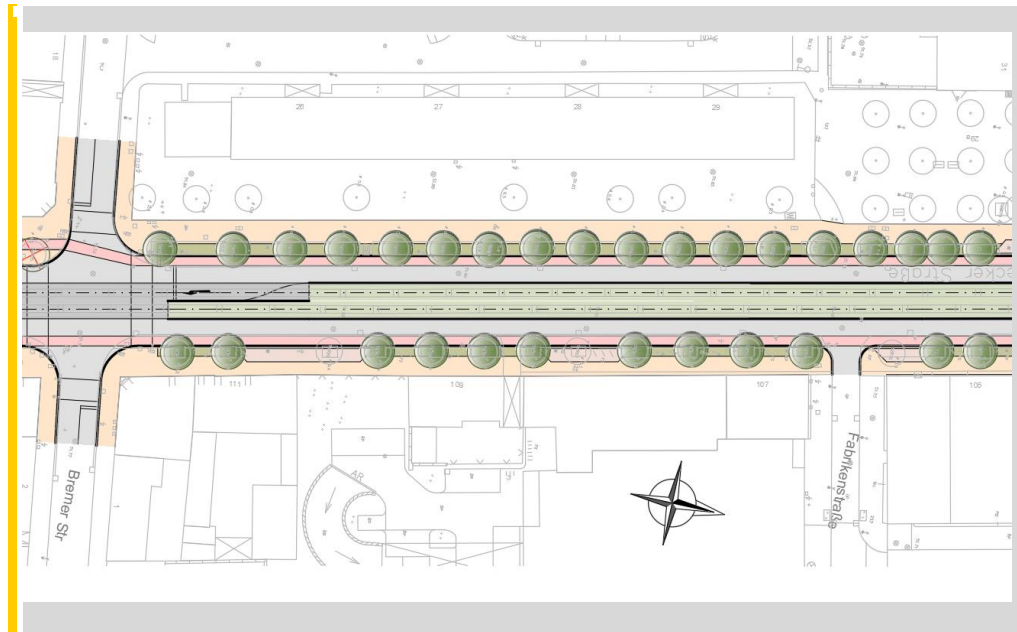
Lübecker Straße Nord, Lageplanausschnitt V1
